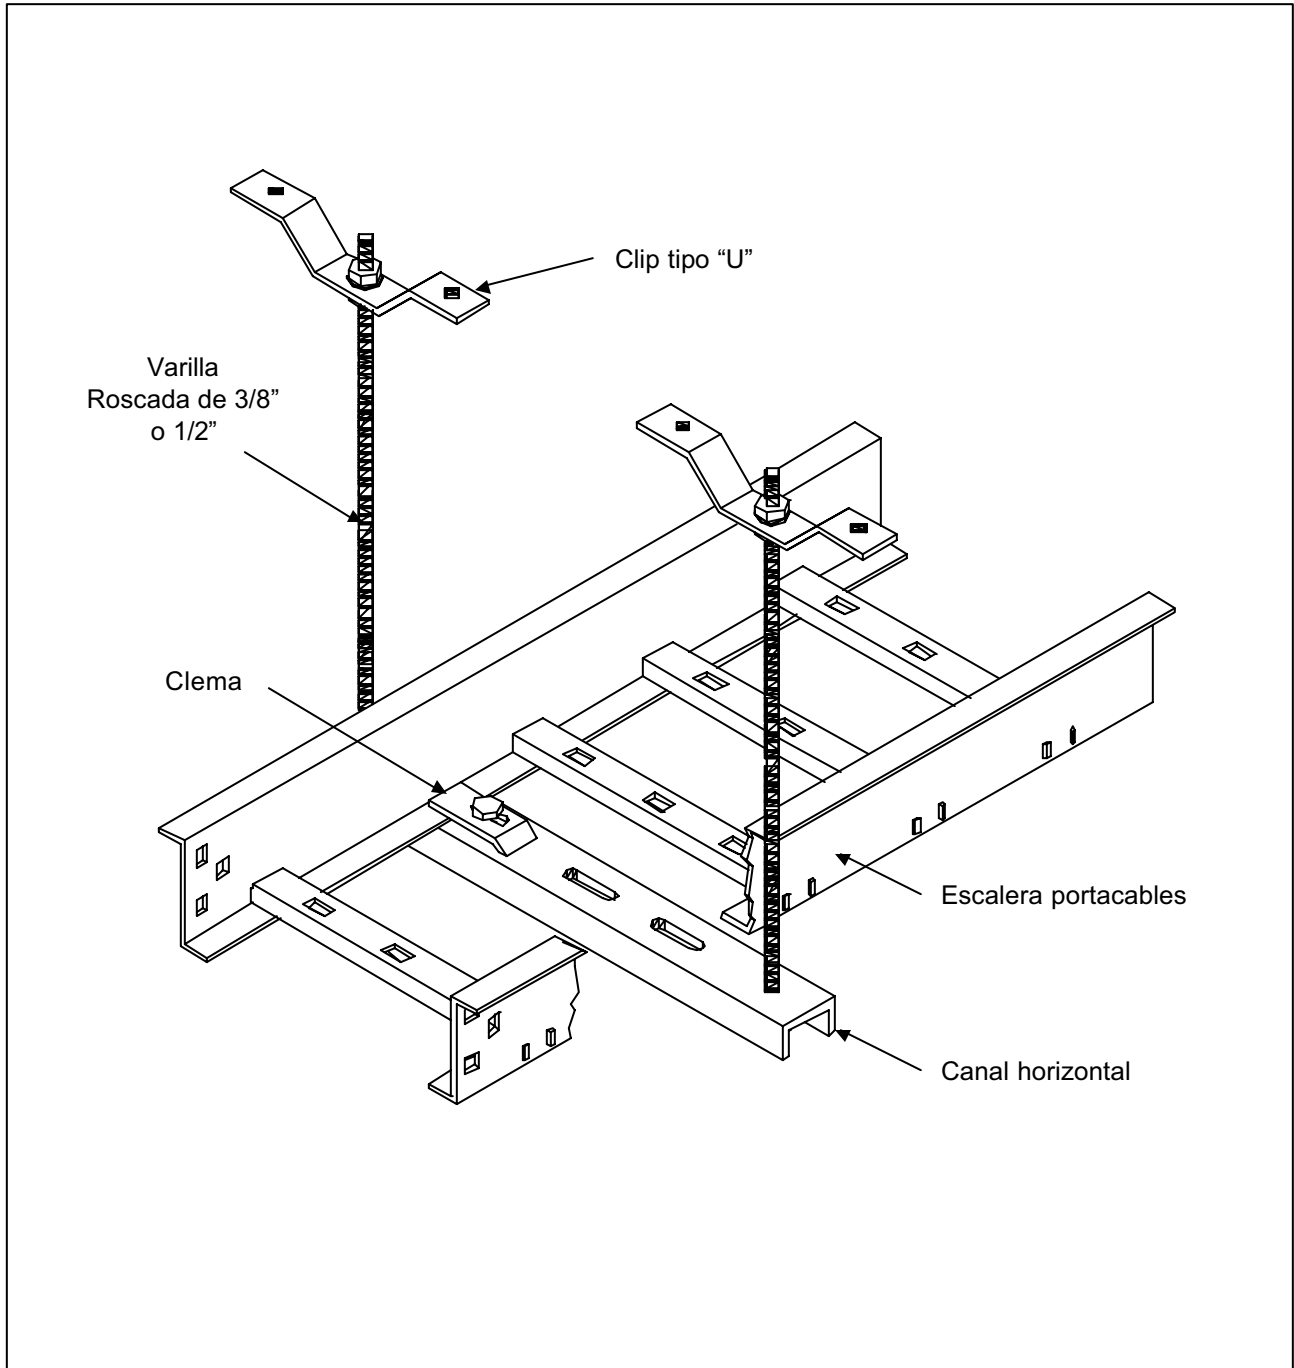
Soporte tipo trapecio para escalera portacables y para sus accesorios de conexión.
